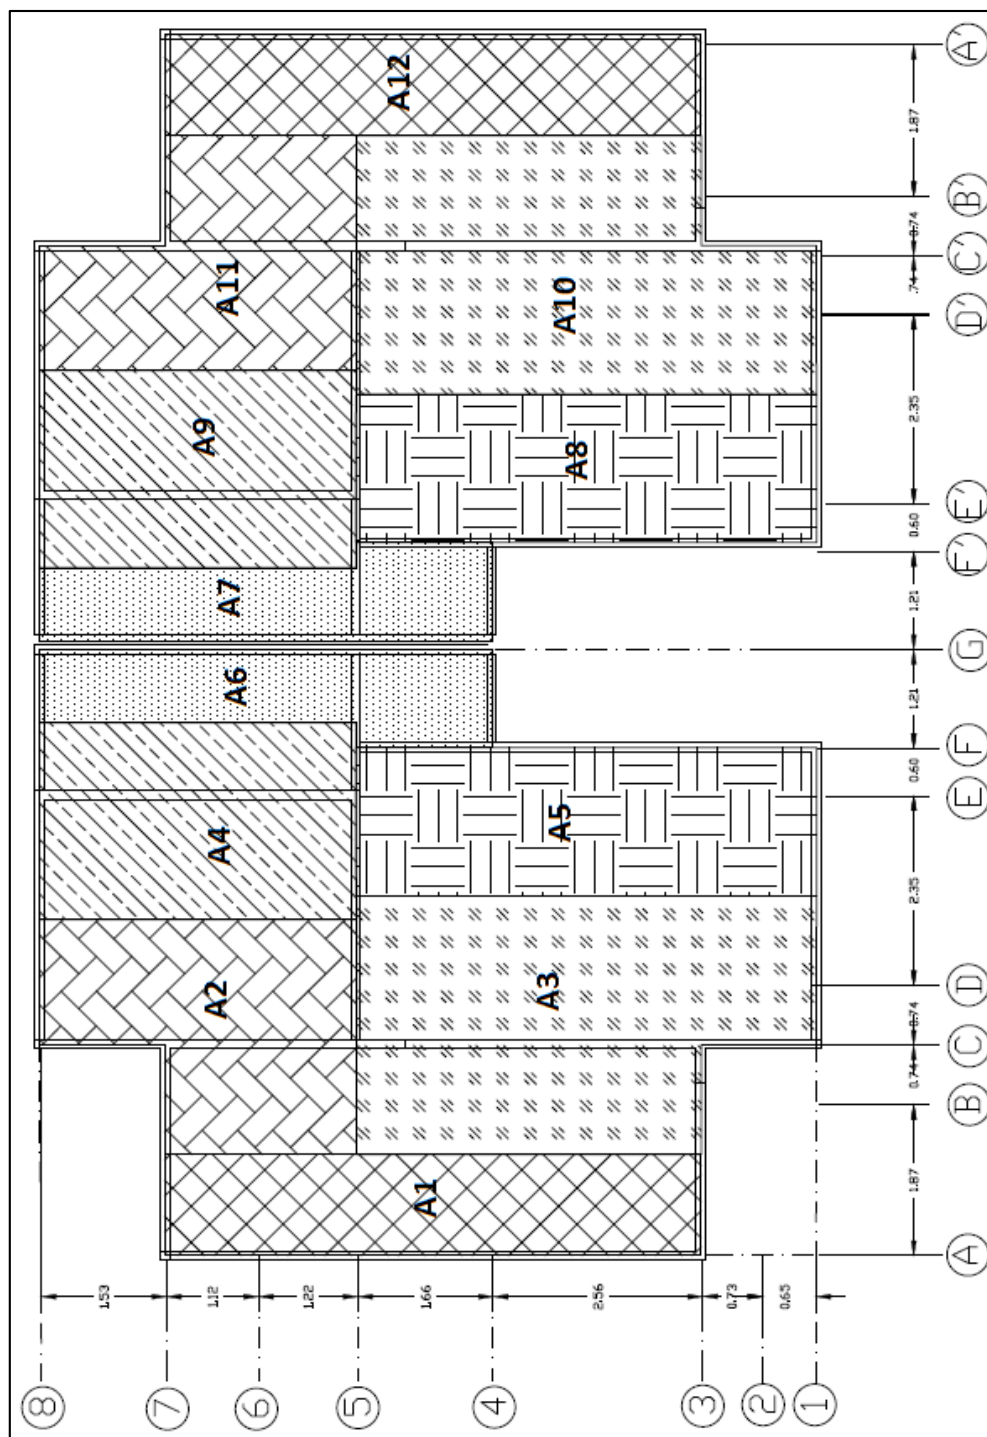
Planta de áreas tributarias cubierta
